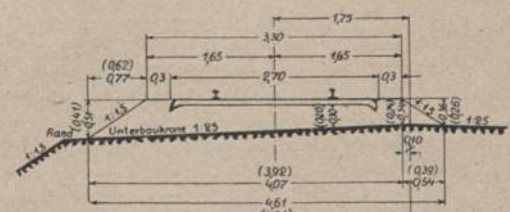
Bettungsquerschnitt eingleisiger Hauptbahnen für Eisenschwellen.
